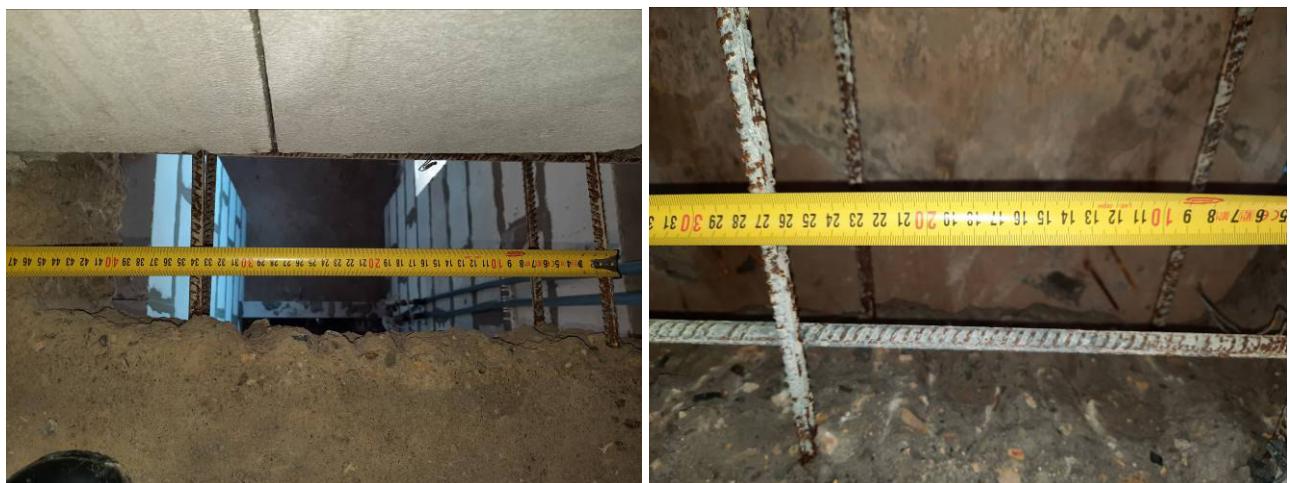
, 80 Шаг армирования плиты перекрытия 34 и 27 см.Фото №№ 81, 82 Шаг армирования плиты перекрытия до 40 см.
